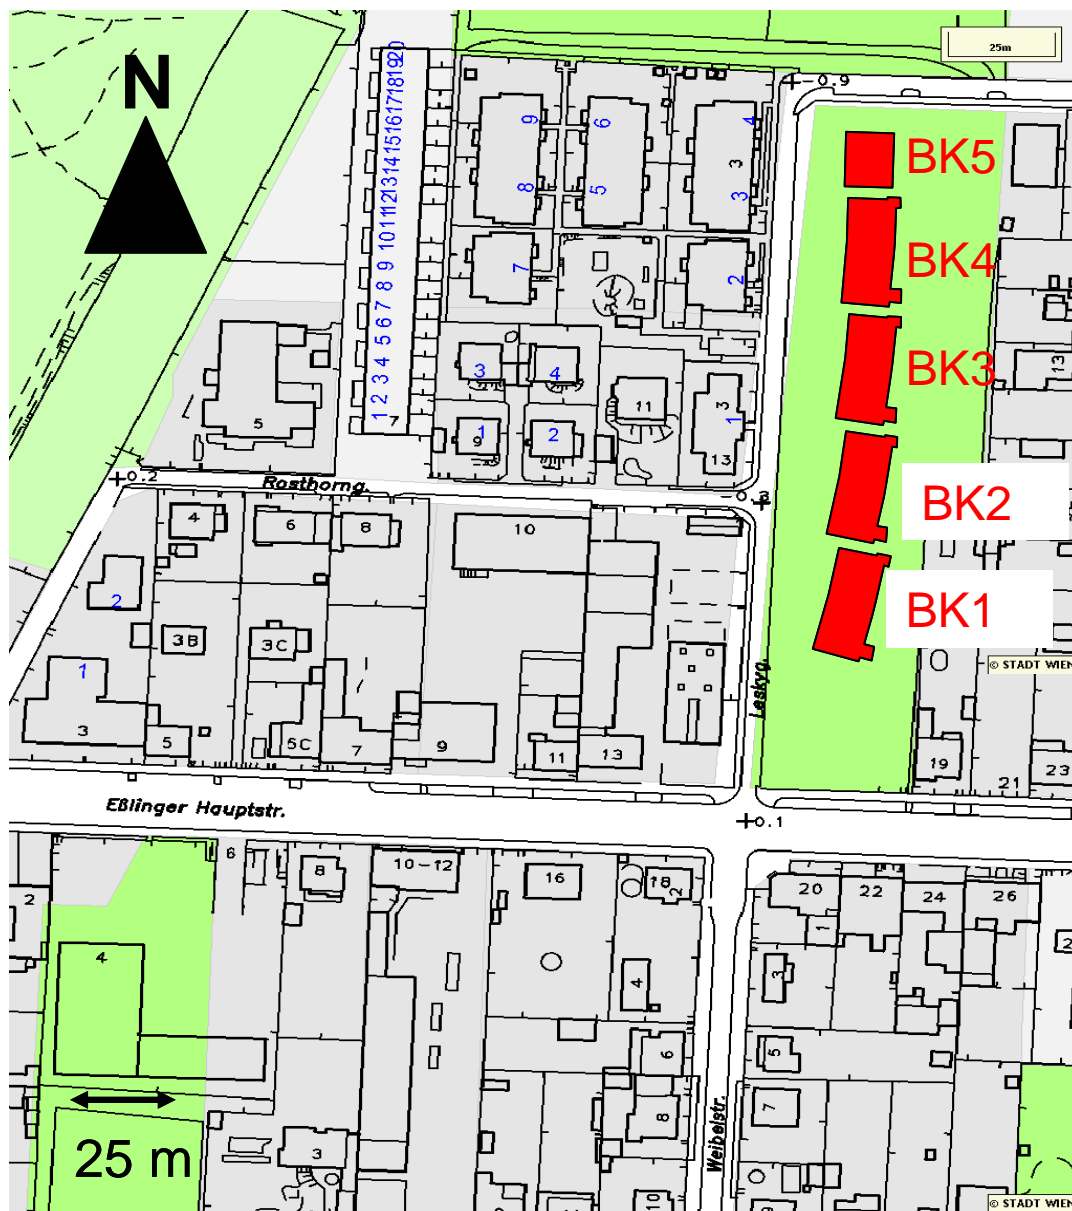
Lageplan des Bauvorhabens Esslinger Hauptstraße 17 mit den 5 geplanten Baukörpern (rot).
